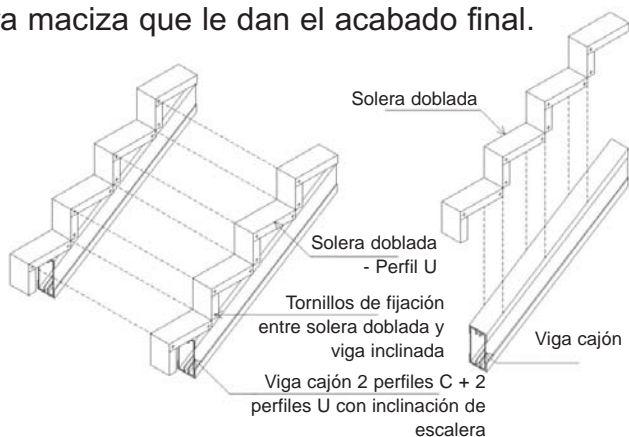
Diseño esquemático de escalera viga cajón inclinada
